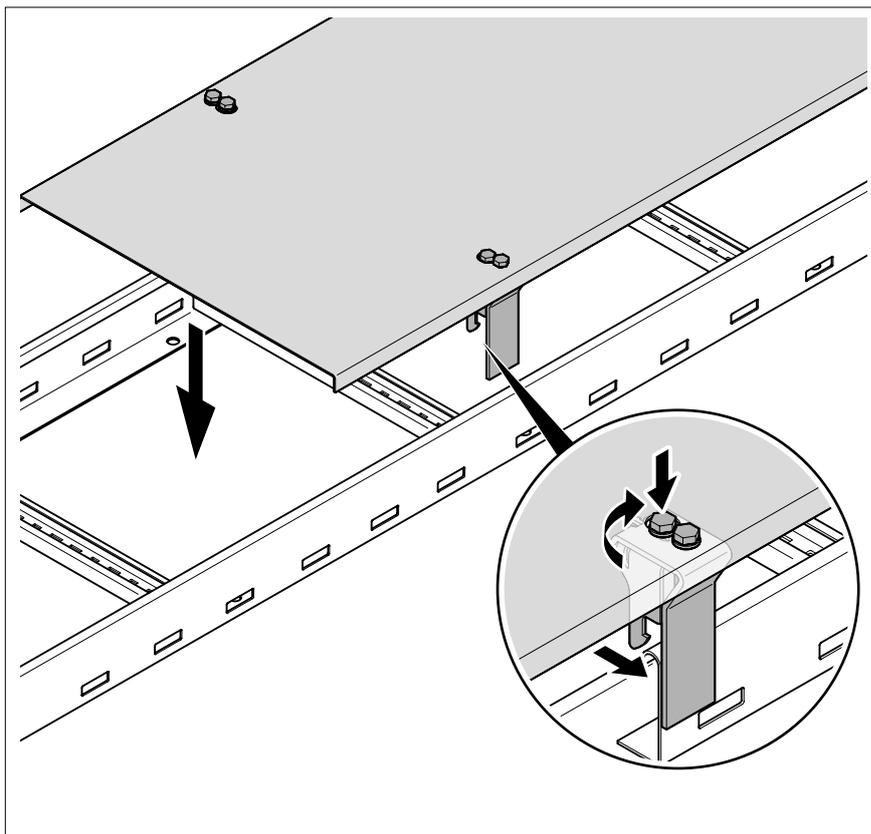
Монтаж крышки на кабельный лоток лестничного типа
